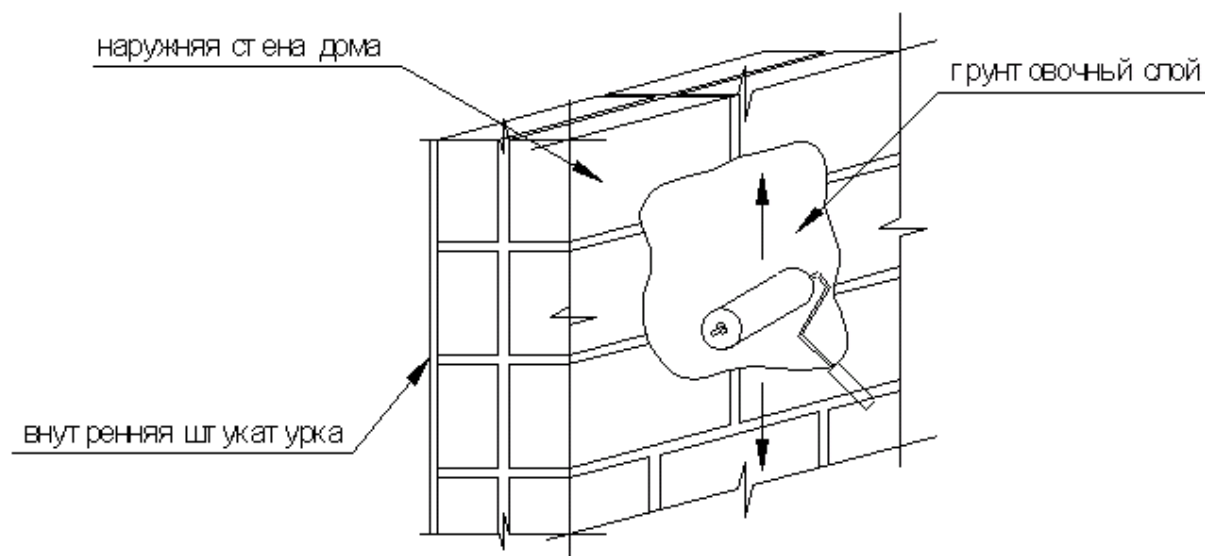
Нанесение грунтовки на наружную поверхность стены
